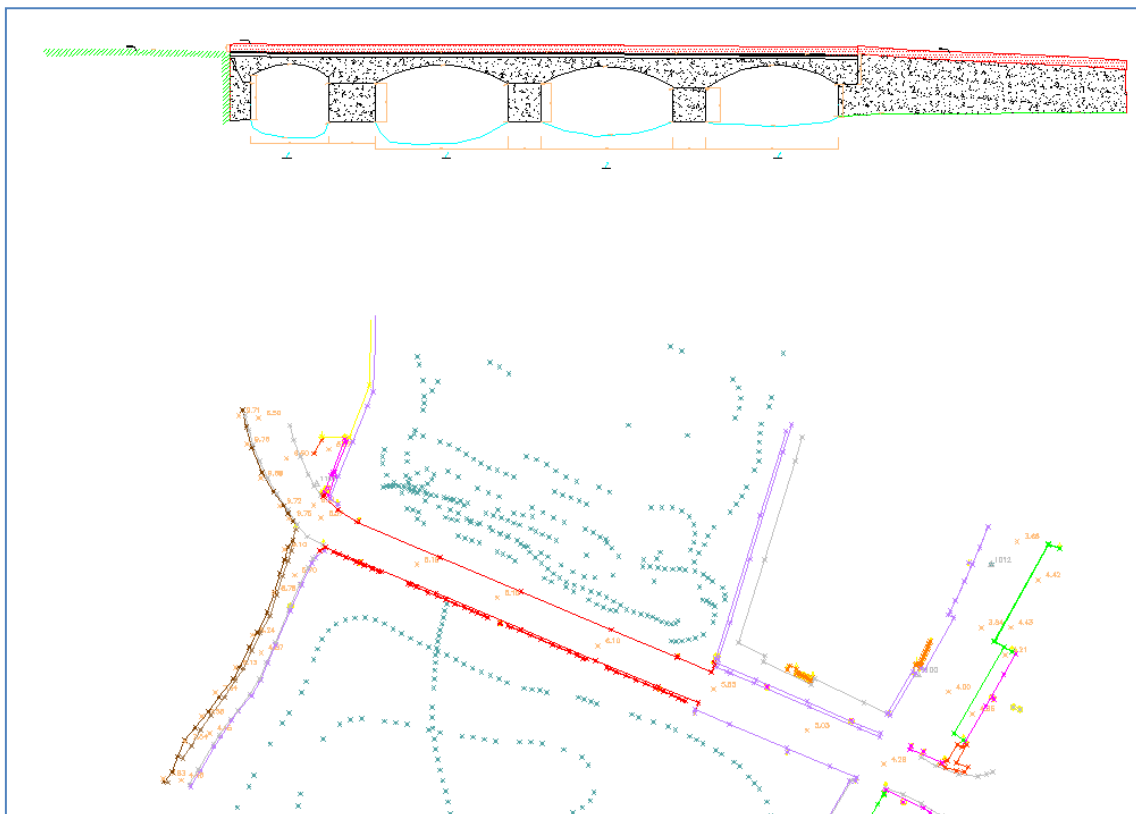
Ejemplo de estructuras existente a revisar. Planta y Alzado.
